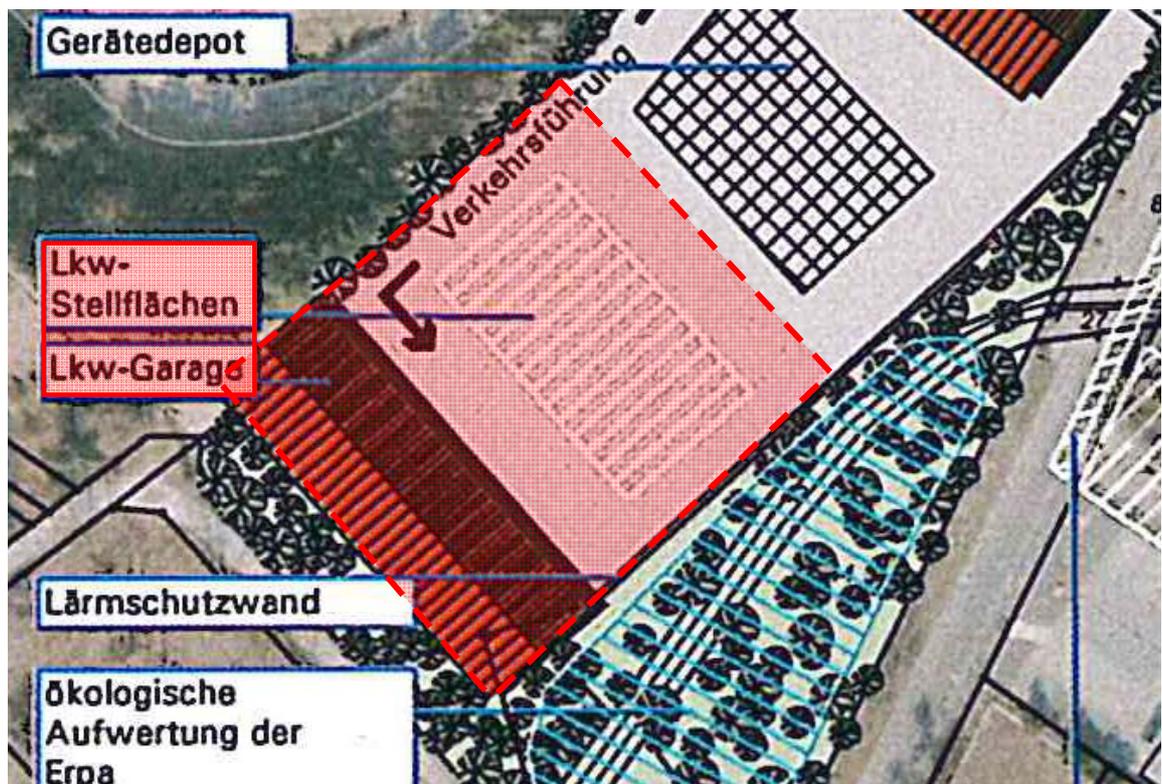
Geplanter Bau einer LKW-Stellfläche und - Garage
